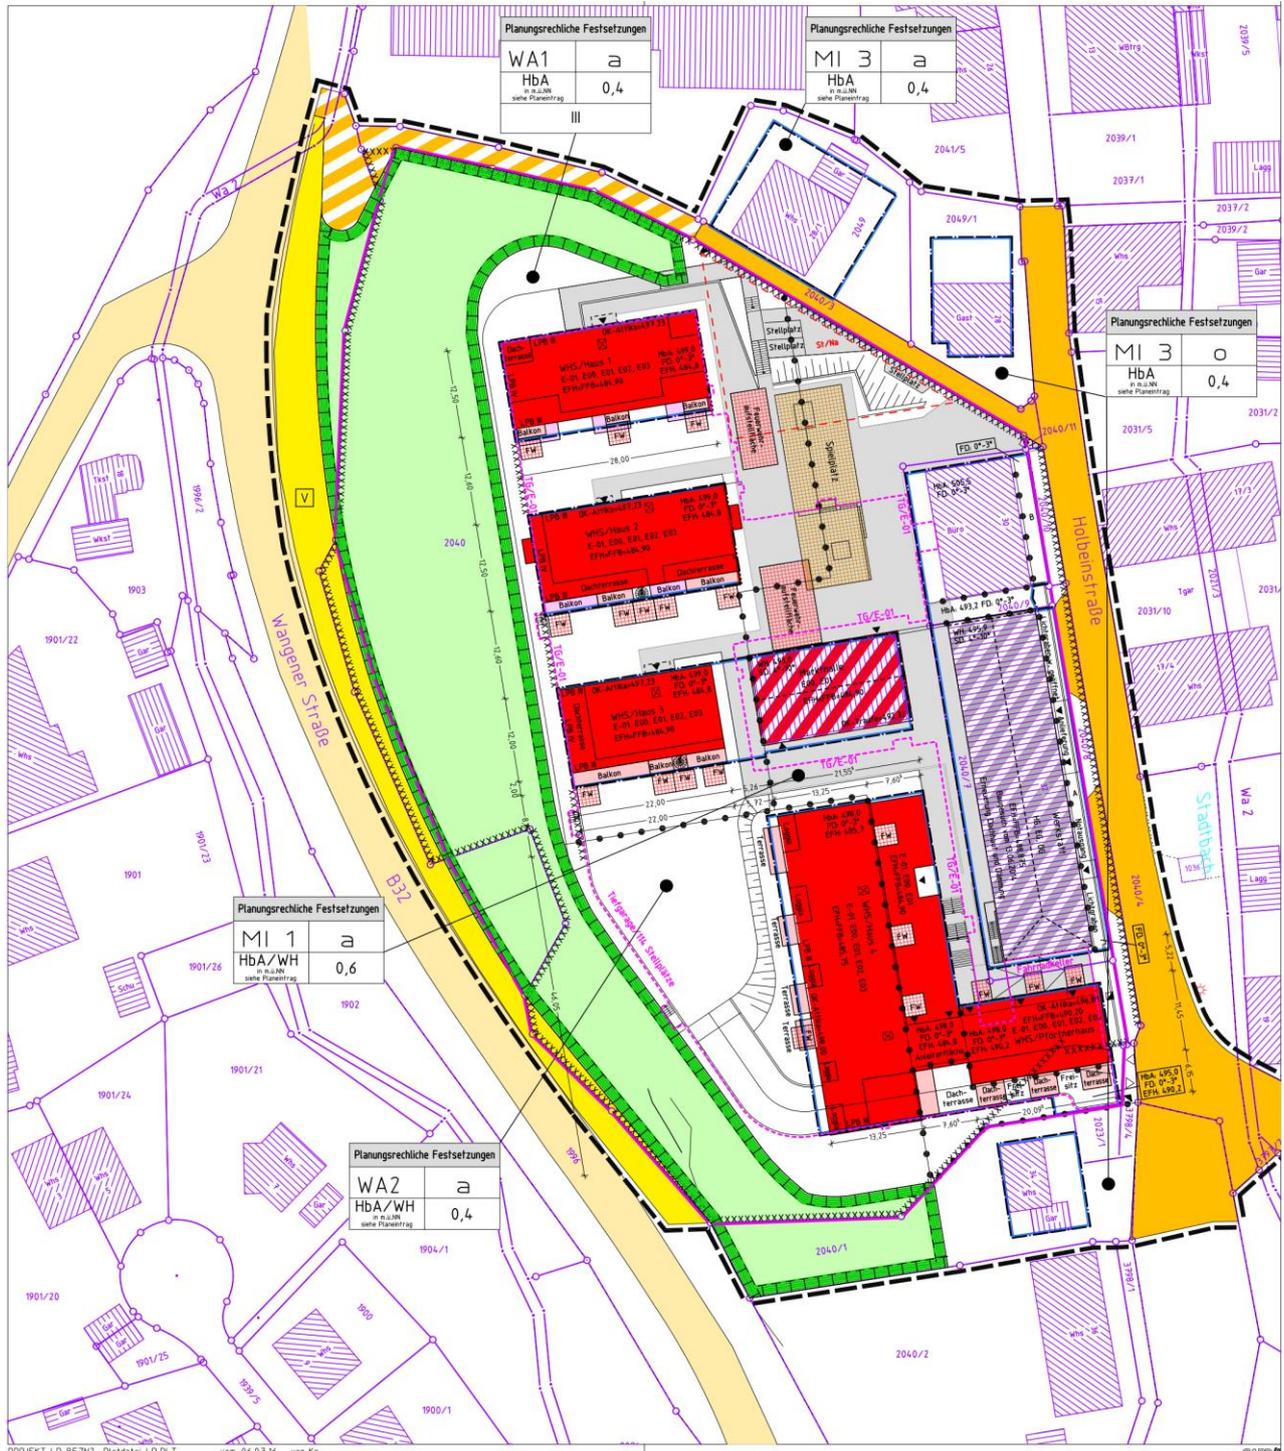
Bebauungsplan Mühlenviertel.
